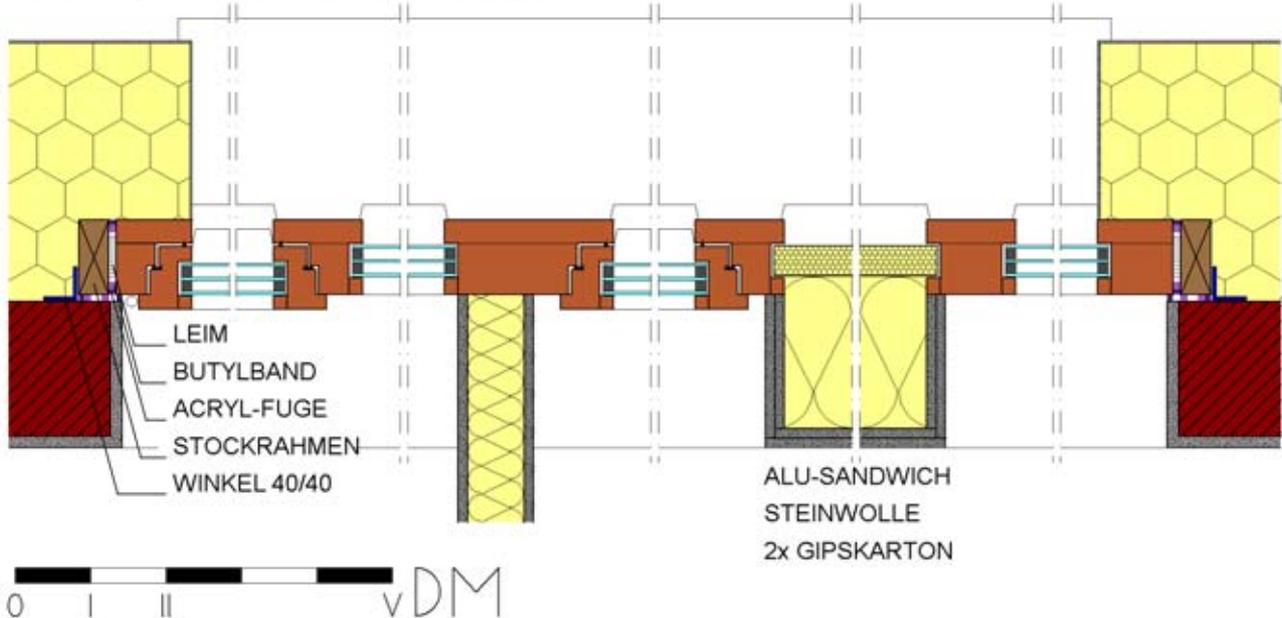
Horizontalschnitt Fenster Nordfassade
